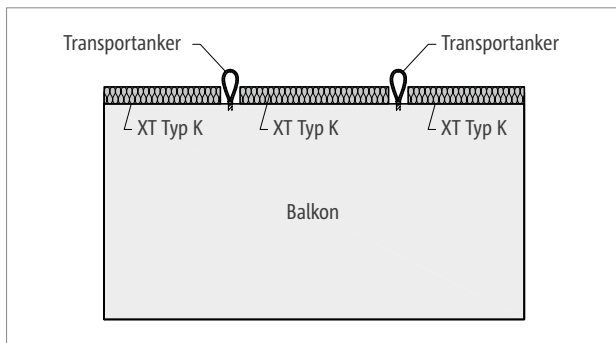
Schöck Isokorb® XT Typ K: Vollfertigteilbalkon mit Transportanker; Dämmzwischenstück XT Typ Z muss beim Bestehen von Brandschutzanforderungen bauseitig eingelegt werden
